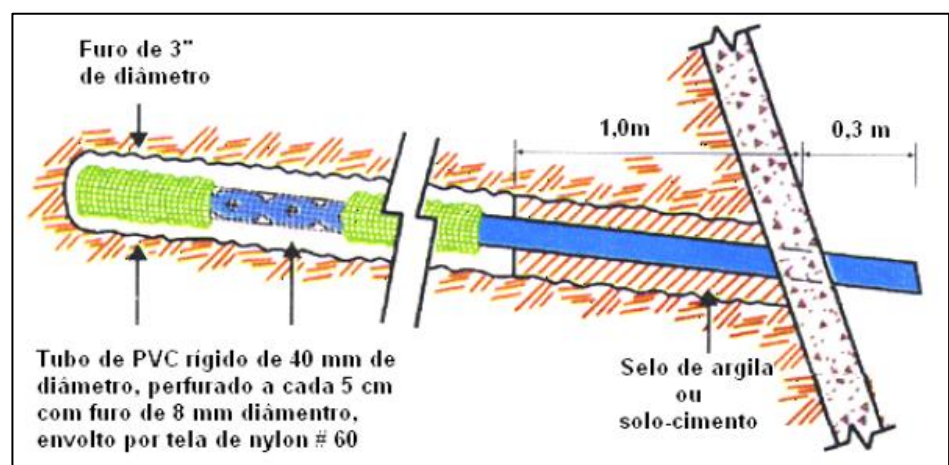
Detalhe do dreno sub-horizontal profundo
